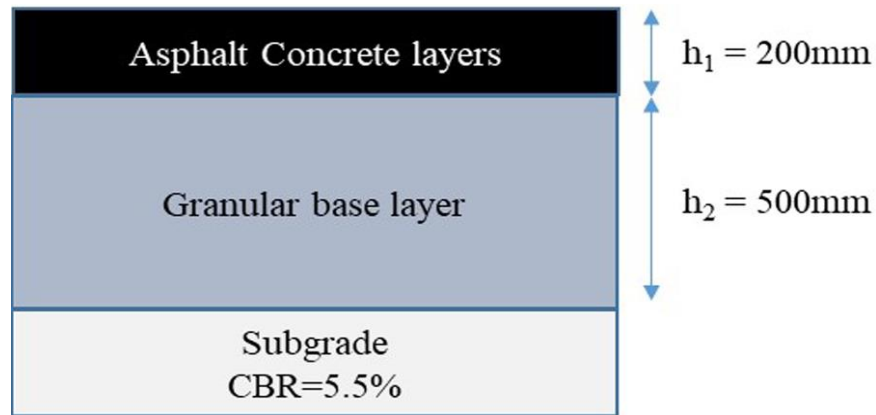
Coupe transversale de la chaussée de la piste d'atterrissage. [7]
